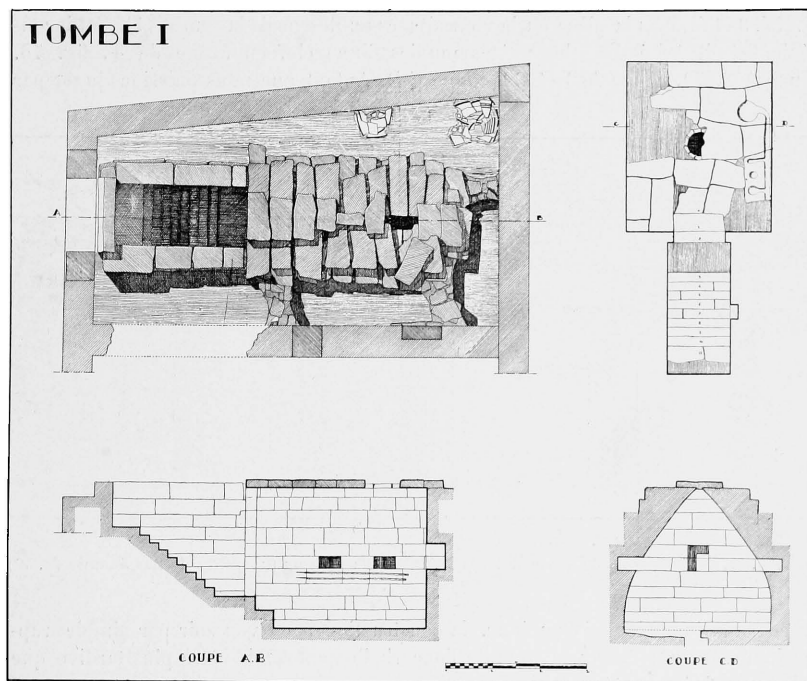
Plan et coupes du caveau I (p. 77, 87, 99).
